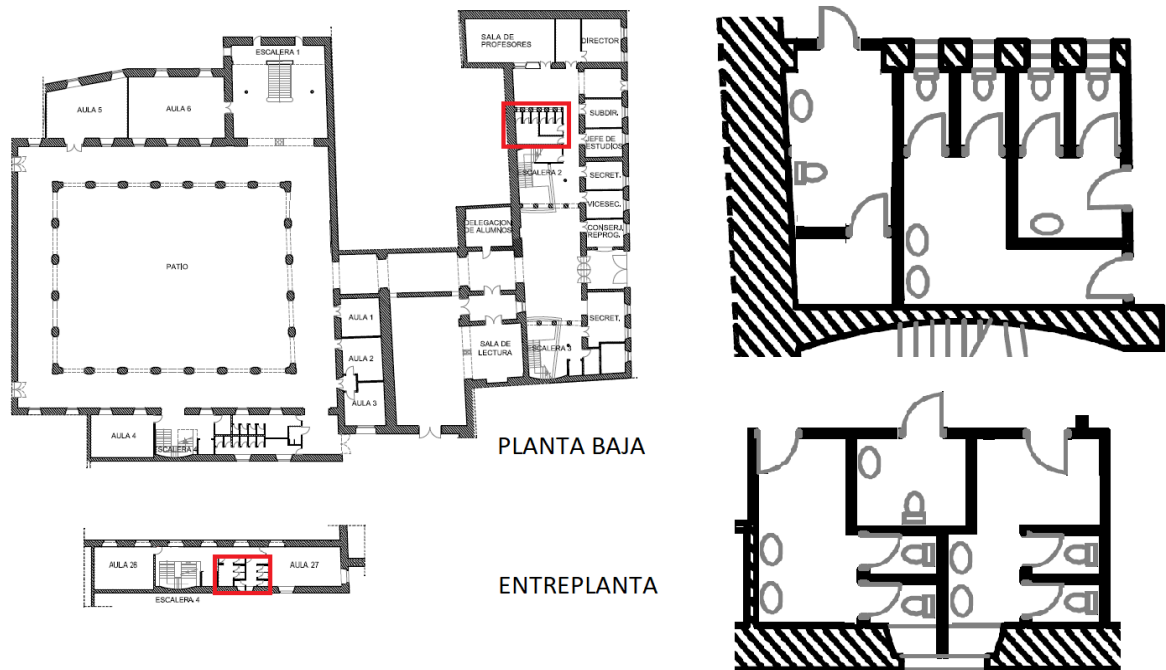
Propuesta de construcción de aseos aislados accesibles. (Fuente: elaboración propia)
